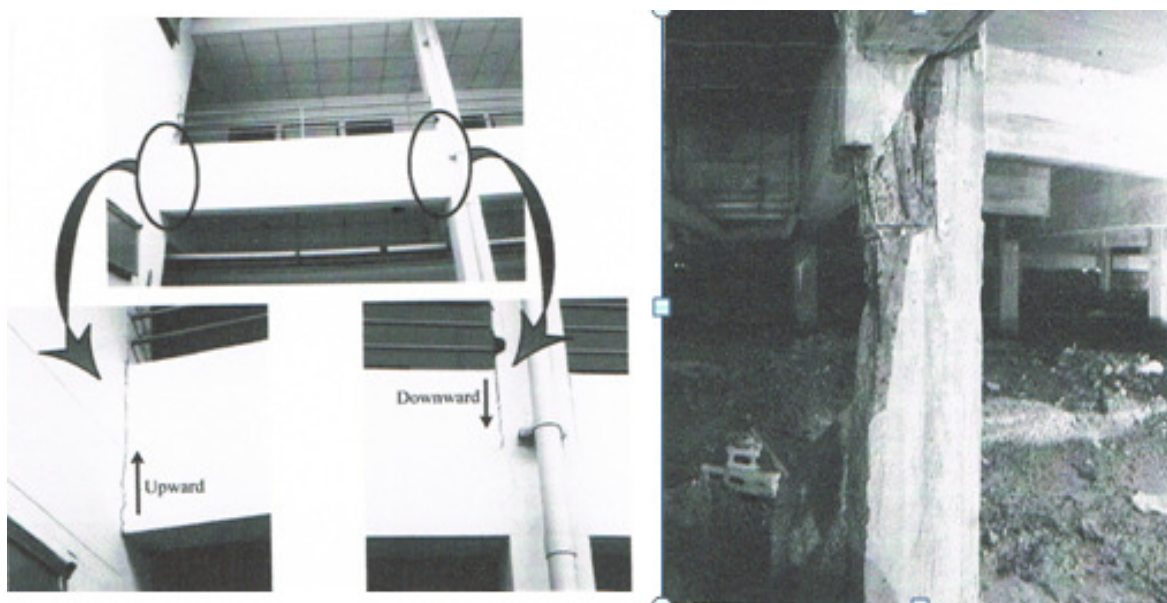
Vista de fissuras em paredes à esquerda e danos estruturais em pilar à direita (Horpibulsuk et al, 2008)
